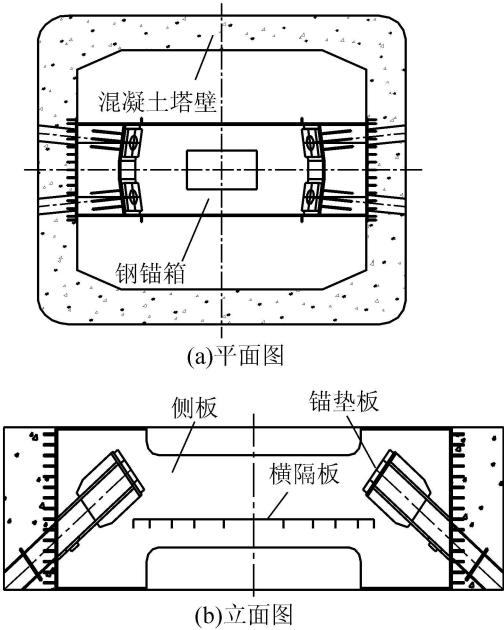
内置式钢锚箱钢-混凝土组合索塔锚固区节段构造
